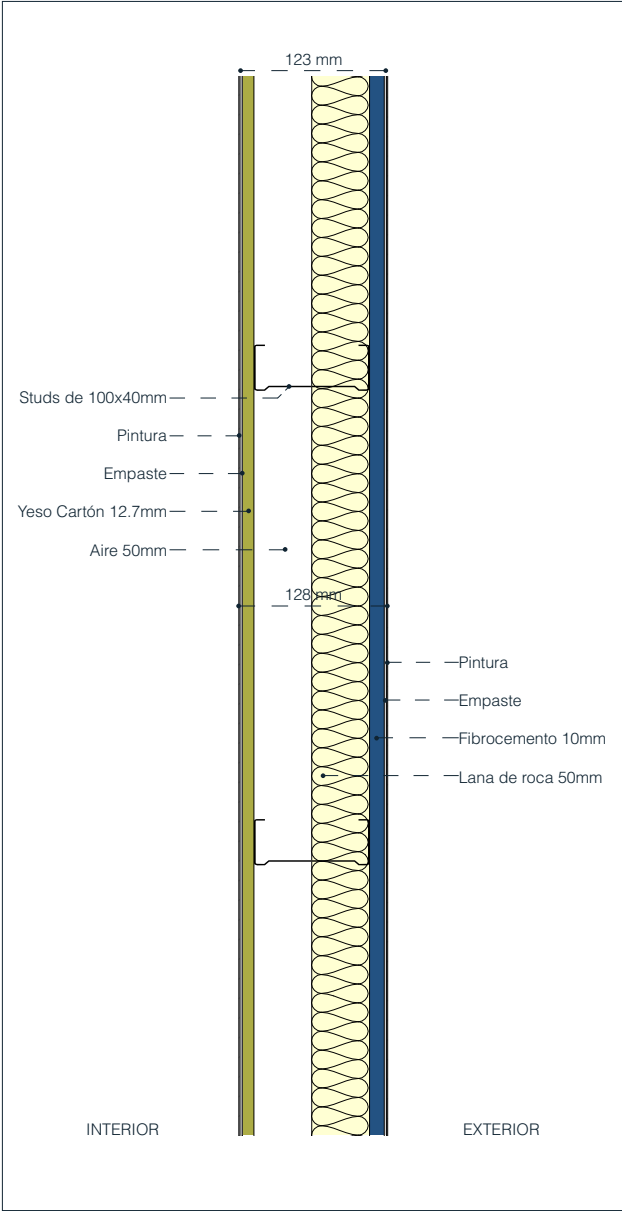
Sección Estructural Tipo de la propuesta de estudio
